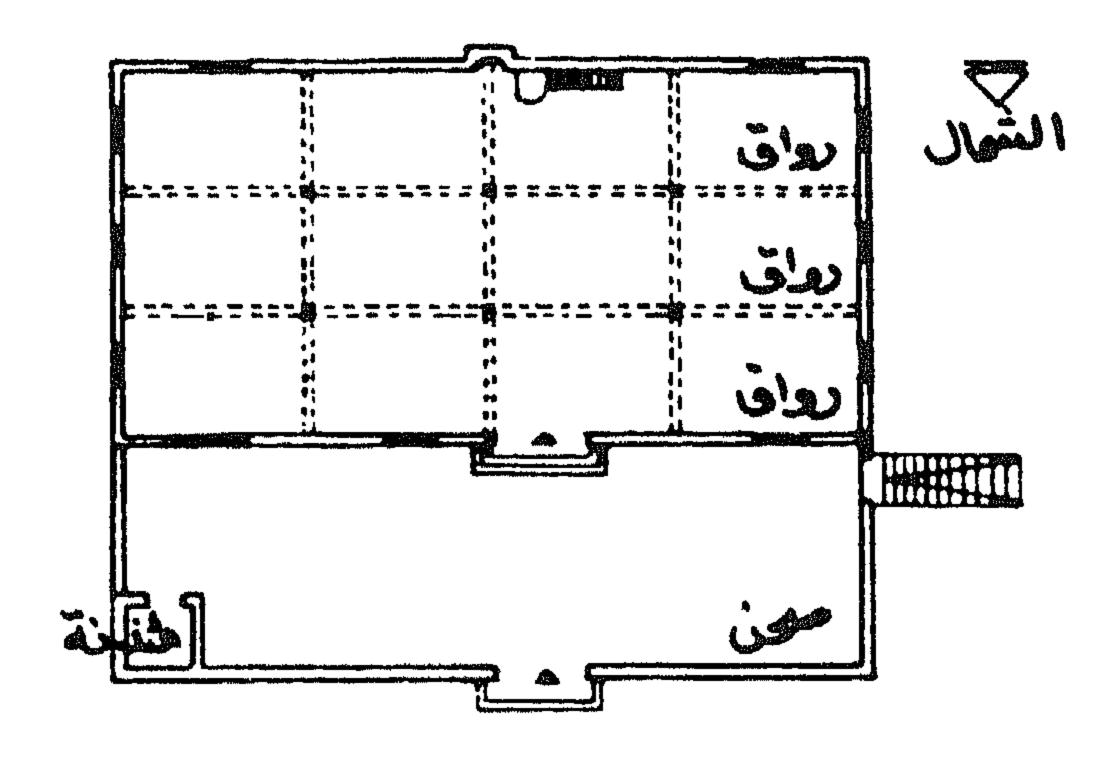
مسقط افقى لمسجد الجمعة للمبنى الحالى
